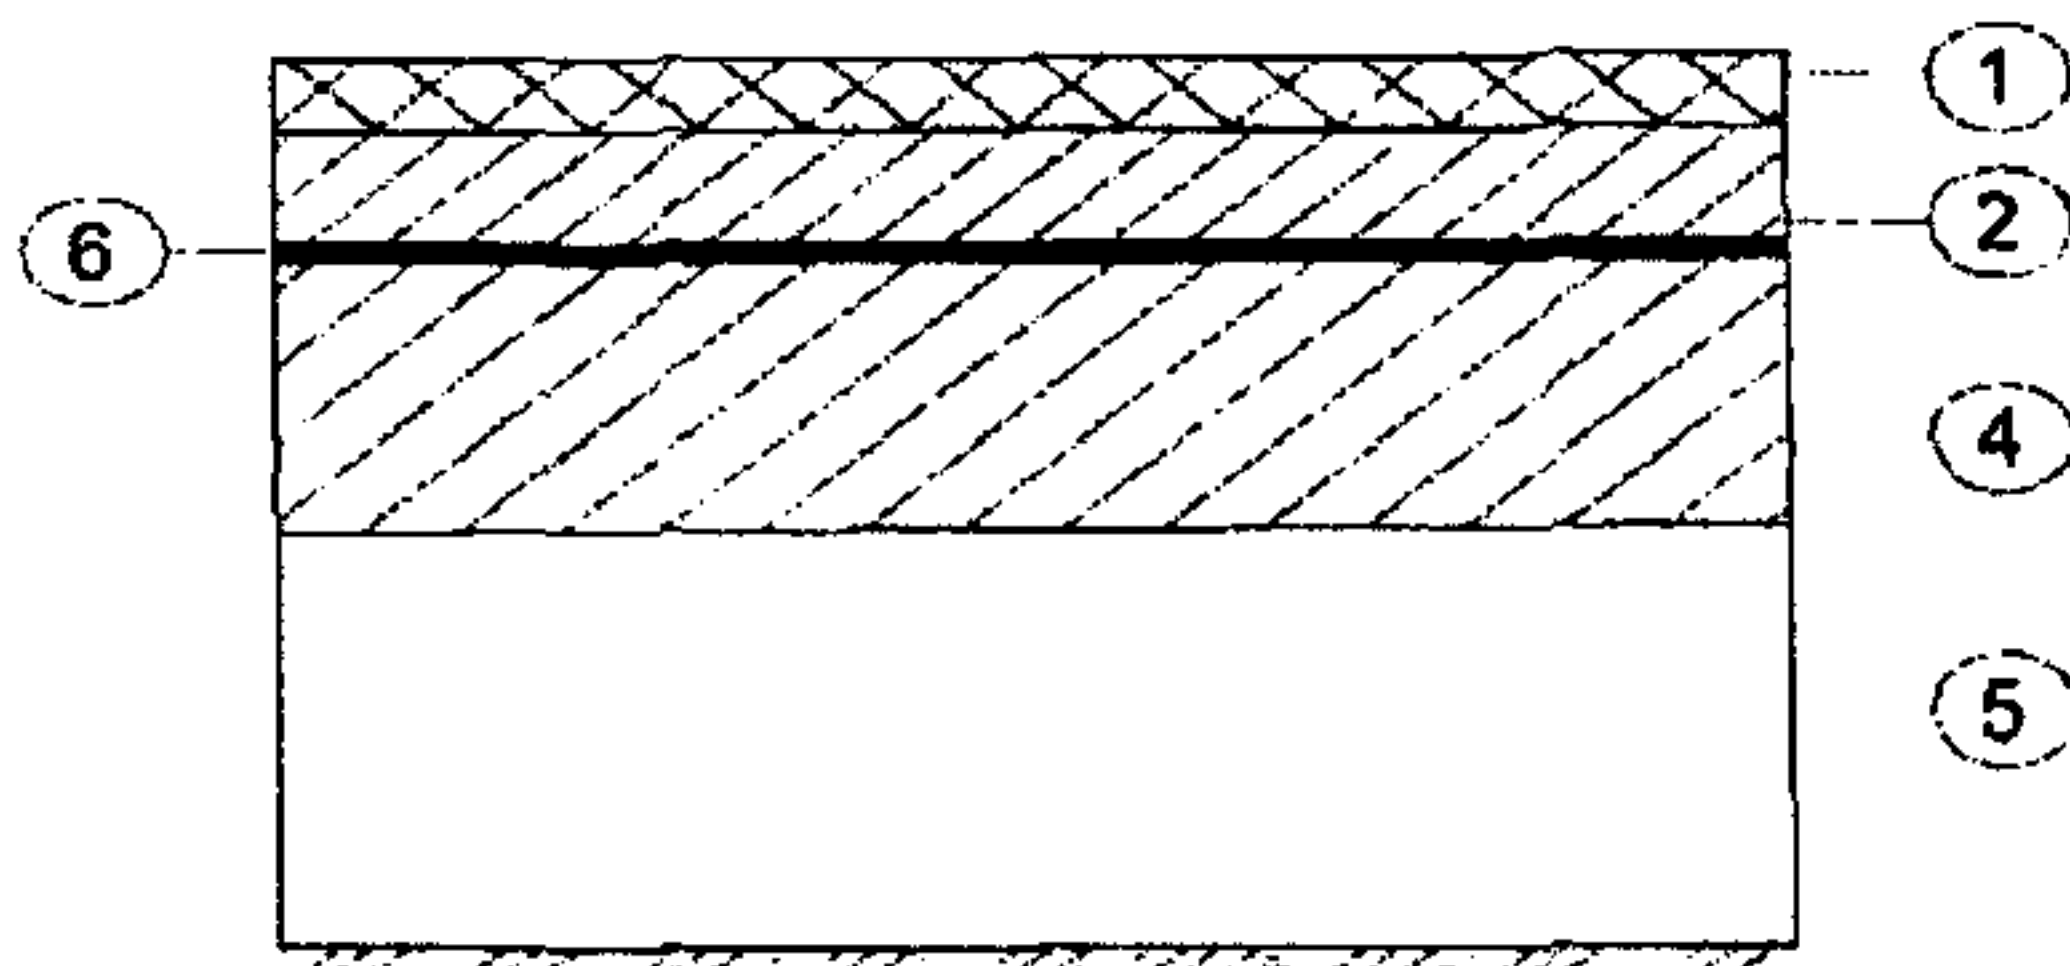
Геосетка уложена на бетонное основание под двухслойным асфальтобетонным покрытием
